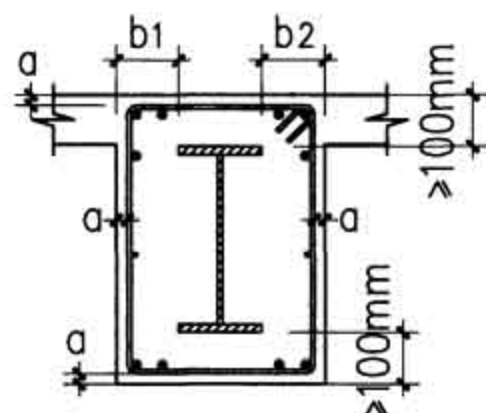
型钢混凝土梁型钢及钢筋保护层要求
